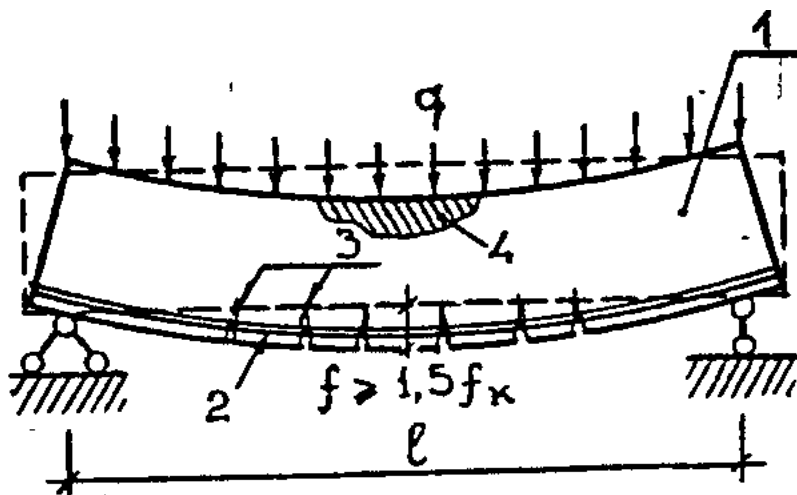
Плинність розтягнутої арматури з одночасним дробленням бетону стиснутої зони :1-досліджувана залізобетонна конструкція; 2 – робоча арматура, напруження в якій досягли границі плинності; 3- тріщини в розтягнутій зоні; 4- дроблення бетону стиснутої зони.
